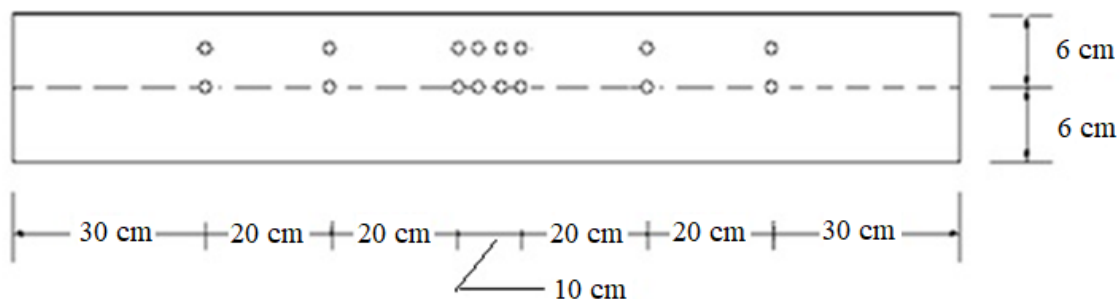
Localização dos termopares ao longo da viga (vista de topo)
